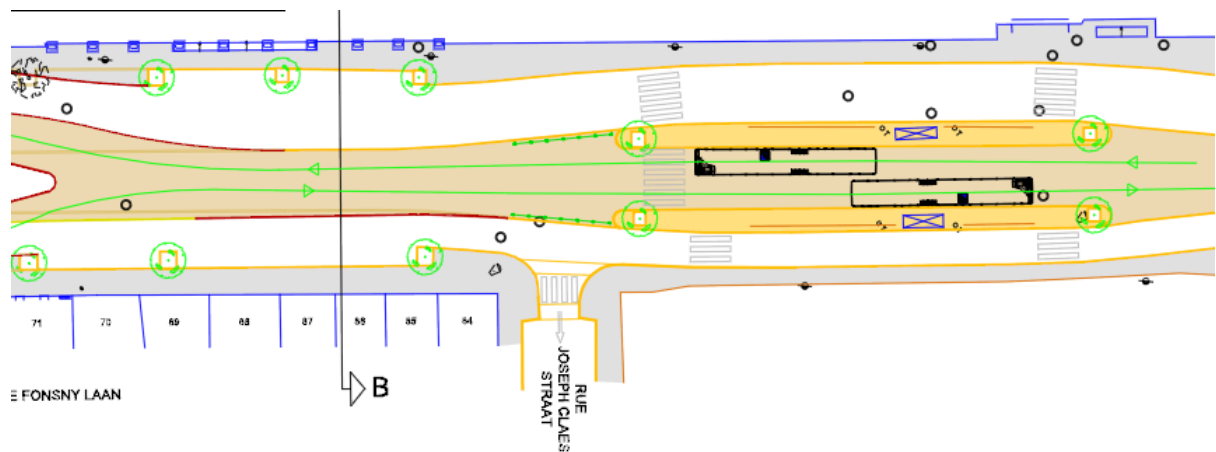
Vue en plan – site propre bus en surface au sein de l'avenue Fonsny
